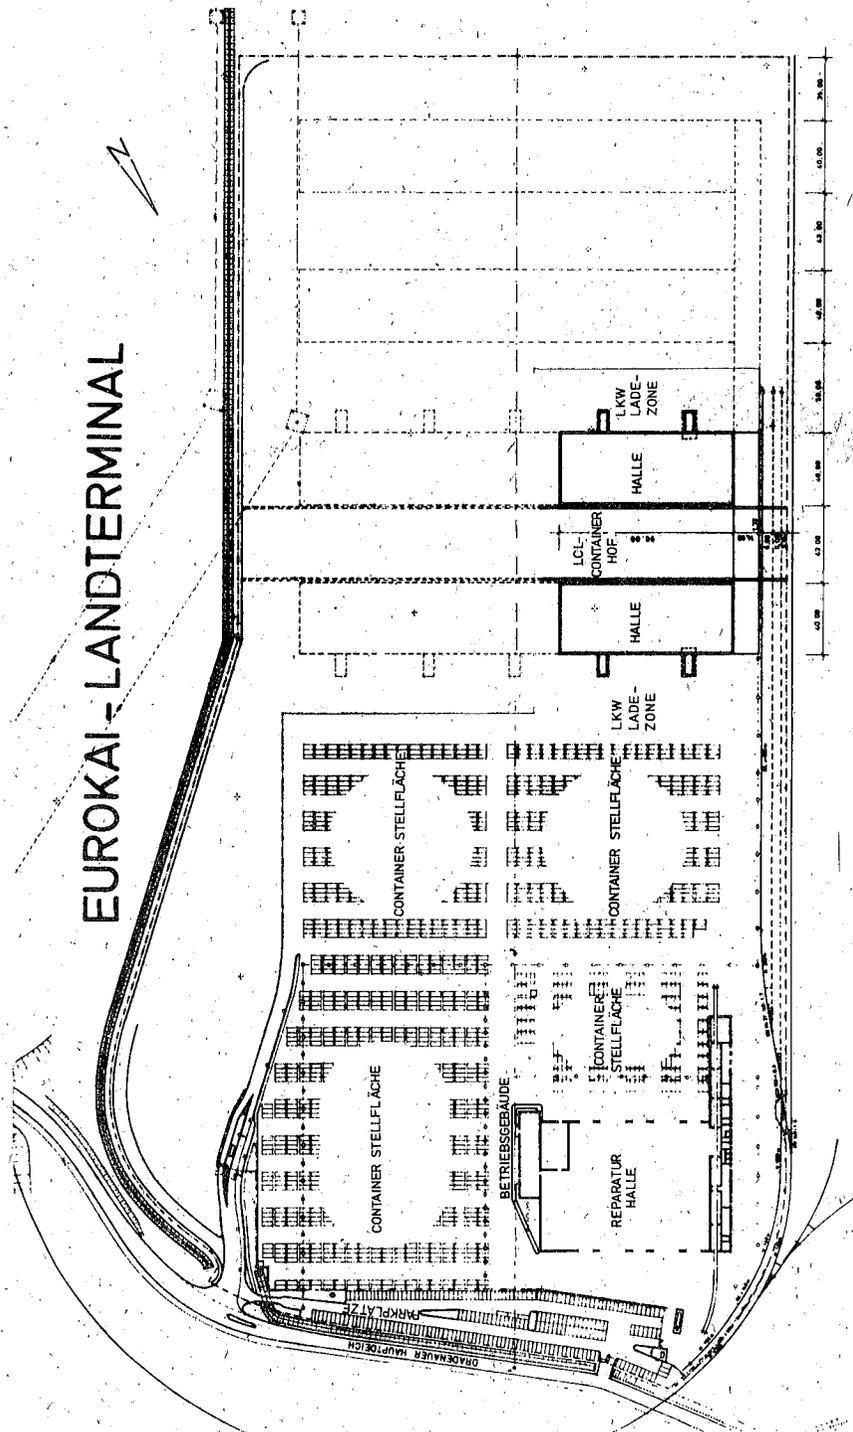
Lageplan der CFS- und Container-Reparatur-Einrichtungen (im Bau) auf dem Euro-Kai-Landterminal
